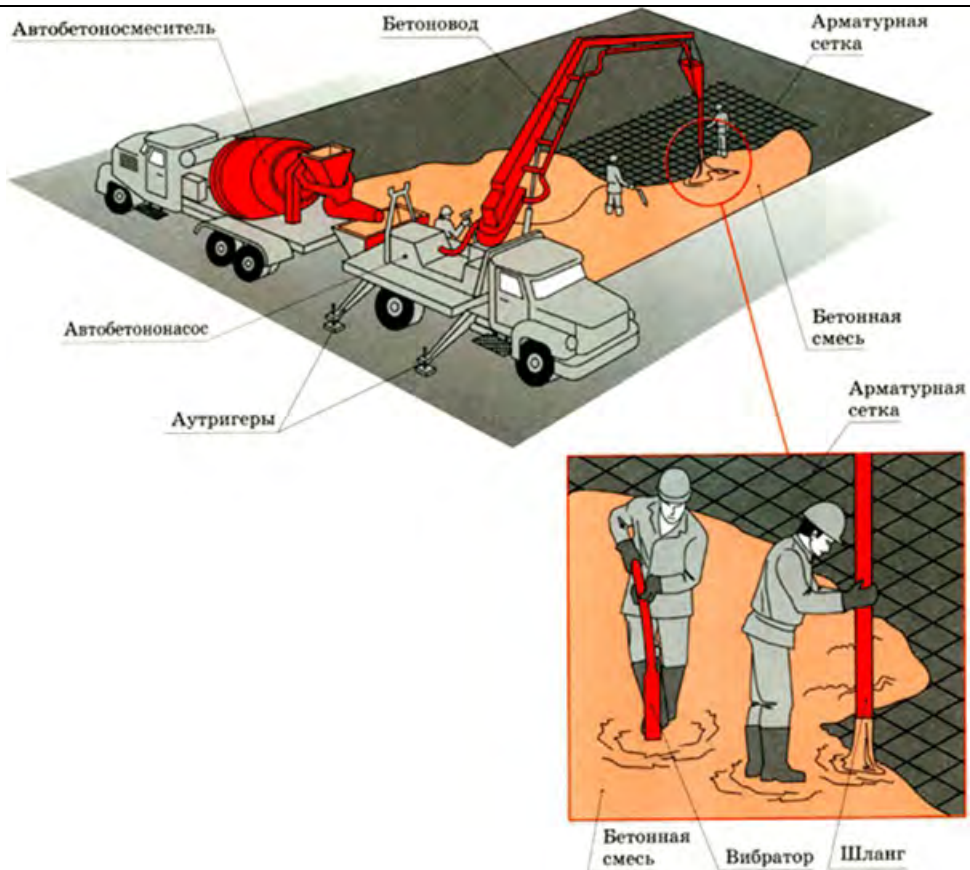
Схема укладки бетона автобетононасосом при устройстве фундаментной плиты
